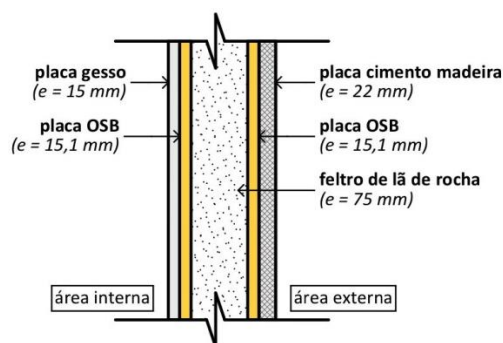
Desenho esquemático da parede externa da casa de steel frame com proposta de modificação
